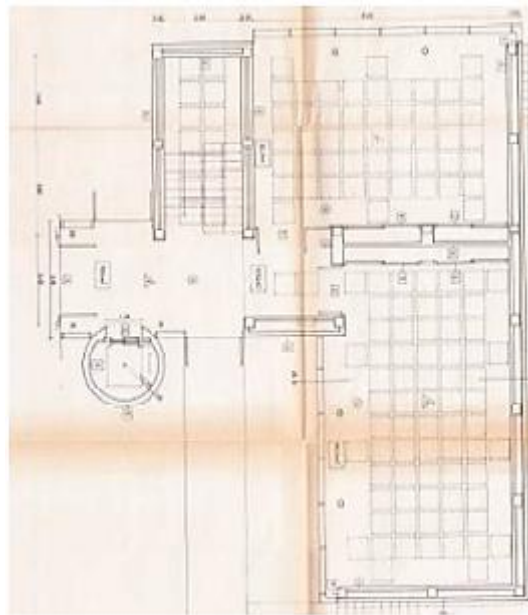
Plano de la vista en planta del edificio de hormigón armado del instituto *Montsacopa* (Casado 2012).
